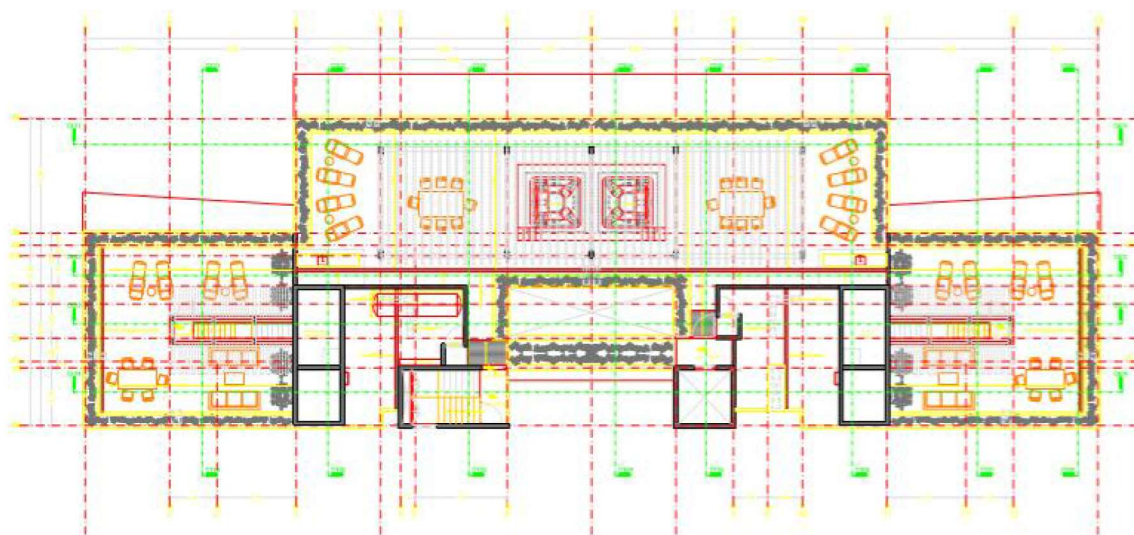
Mapa de obras del proyecto en planta baja del Edificio A.
